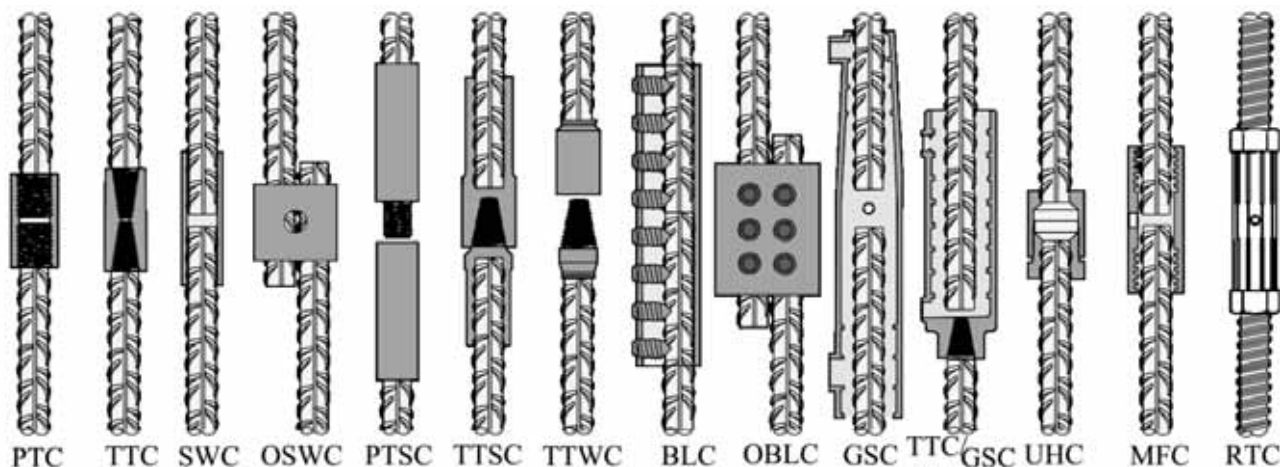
Виды механических соединений, применяемых за рубежом. (Напезные: PTC Parallel threaded, TTC Taper threaded, PTSC Cold forged sleeve with parallel threads, TTSC Cold forged sleeve with taper threads, TTWC Taper threads from welded heads; (Обжимные: SWC Swaged, OSWC Offset wedge swaged, BLC Bolt lock, OBLC Offset bolt lock); (С заполнителями: GSC Grouted sleeve, TTC/GSC Taper threaded-Grouted sleeve; (Другие: UHC Upset headed, MFC Metal filled, RTC Rib thread)
